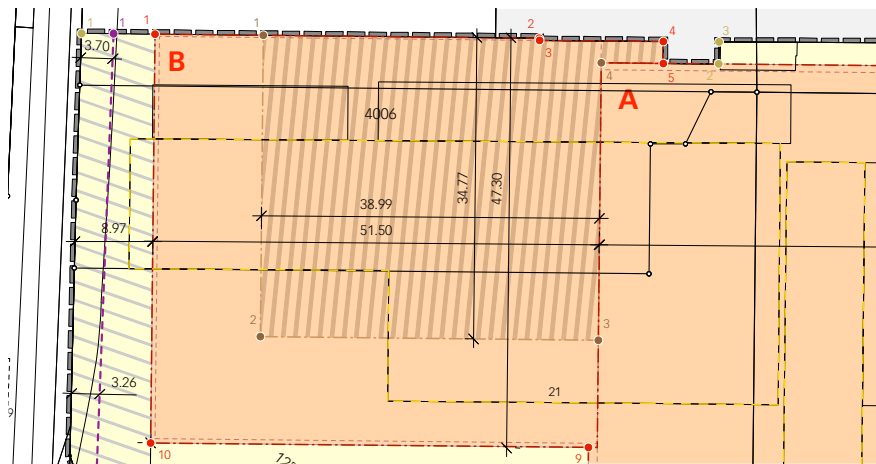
Ausschnitt Überbauungsplan: Baubereich B (orange) sowie schraffierter Bereich für Attikageschoss und nicht technisch bedingte Dachaufbauten.
